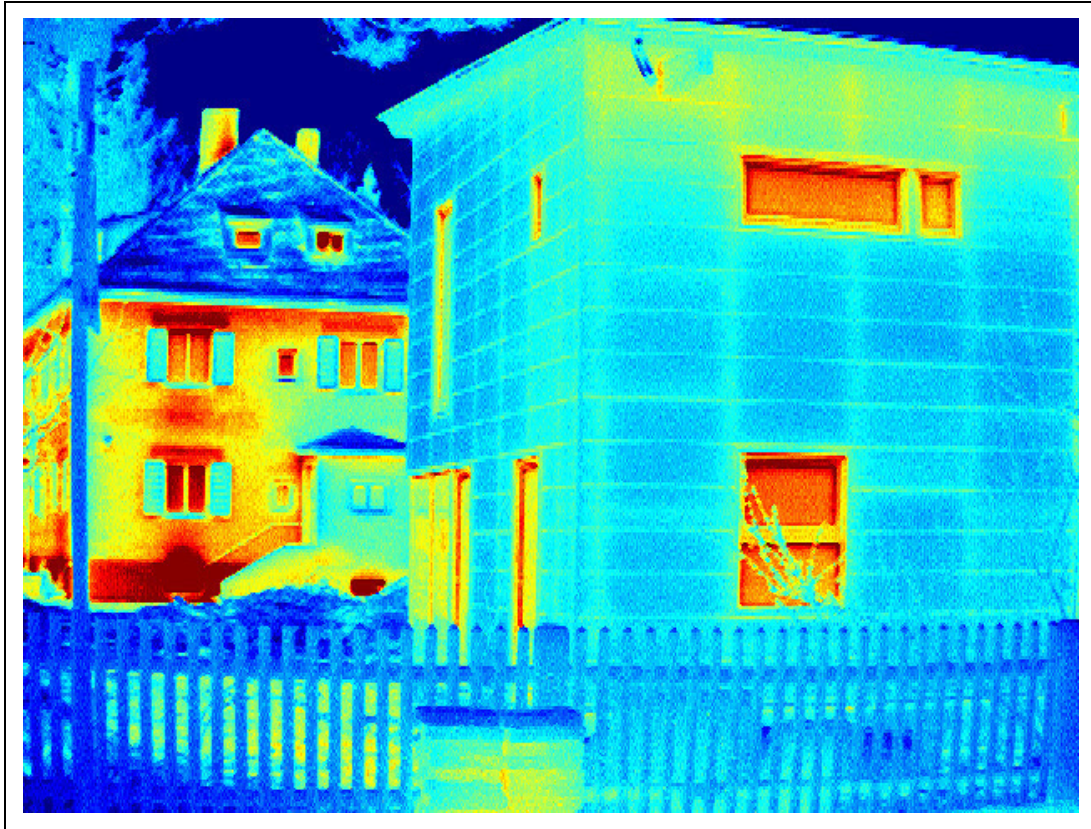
Infrarotaufnahme eines mit Vakuumschutzpaneelen gedämmten Neubaus (rechts) und einem nicht wärmegeprägten Altbau (links).
